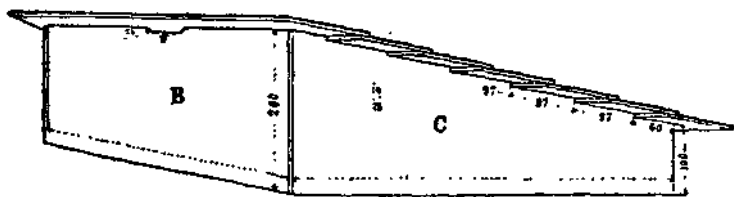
Крыша, покрытая деревянными дощечками. В — передняя стенка, С — боковая стенка, У — вентиляционное отверстие.
